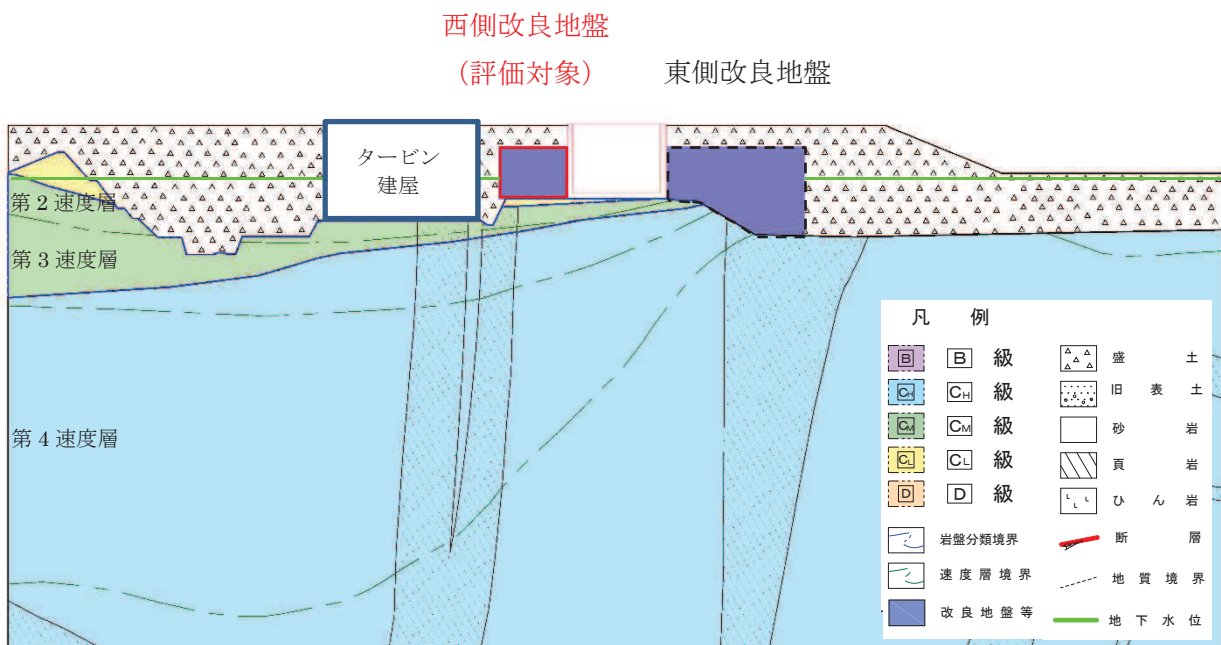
2号放水立坑改良地盤の評価対象断面 地質断面図 (A-A断面)
